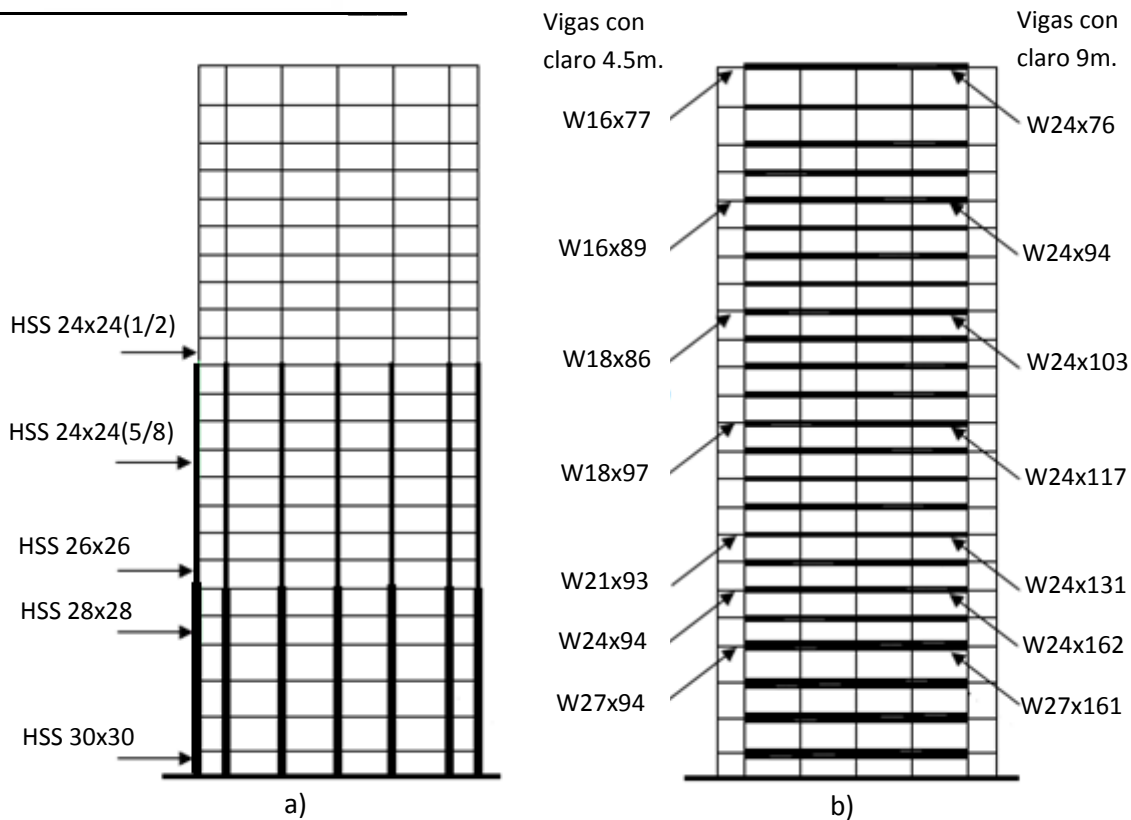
Perfiles en marco rígido de acero: a) Columnas, b) Vigas.
